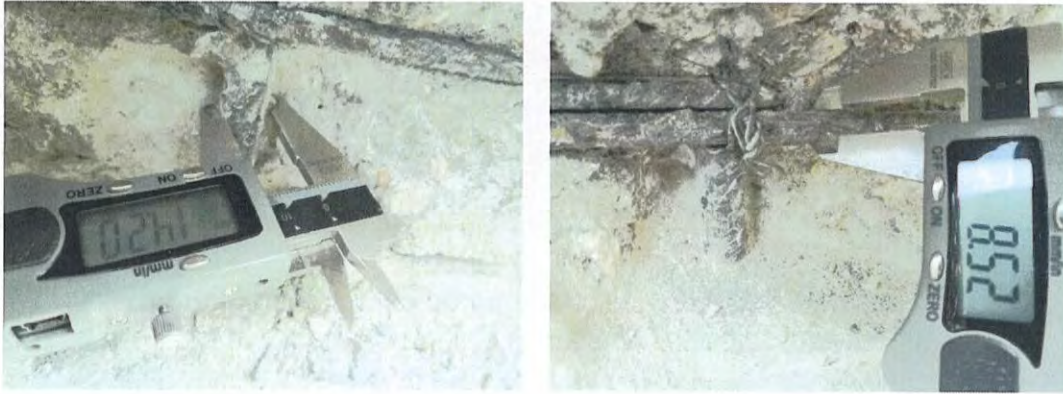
a, b– Aspect sondaje armare consolidări elevații
